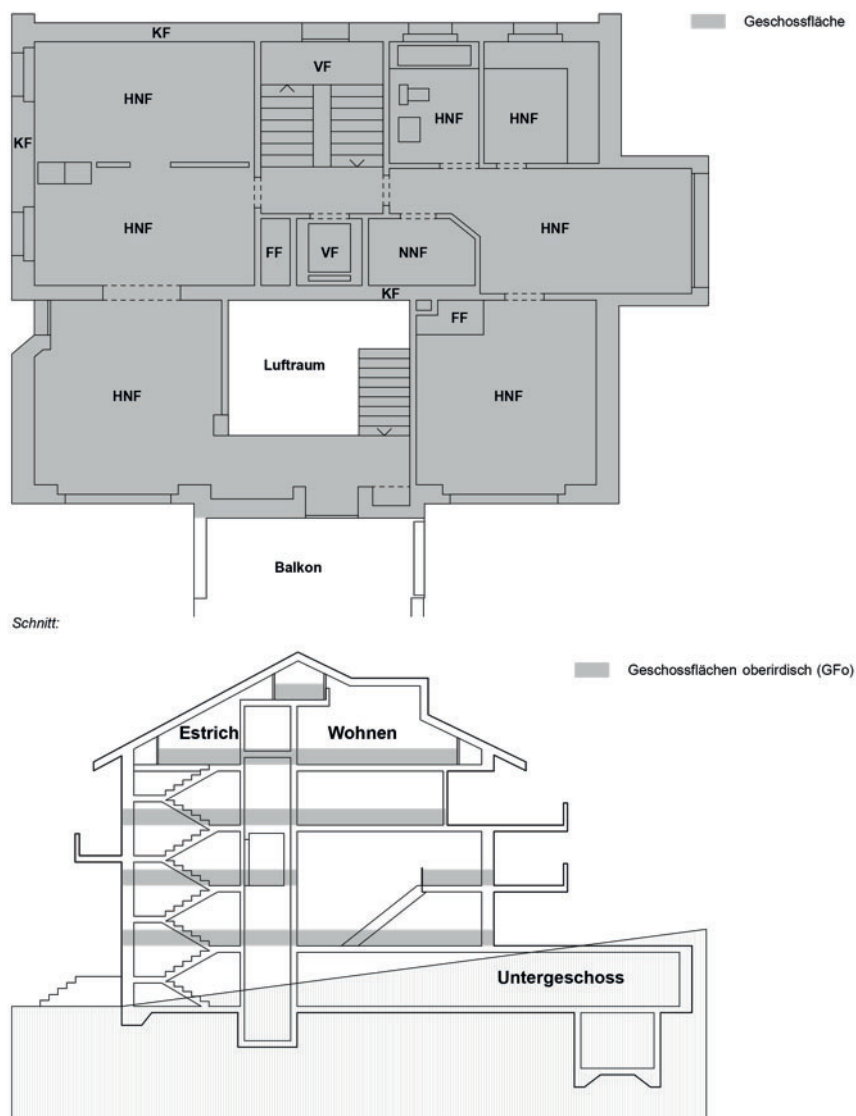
Geschossflächen und Geschossflächen unterirdisch (Neu Skizze Anhang 7 BR)
